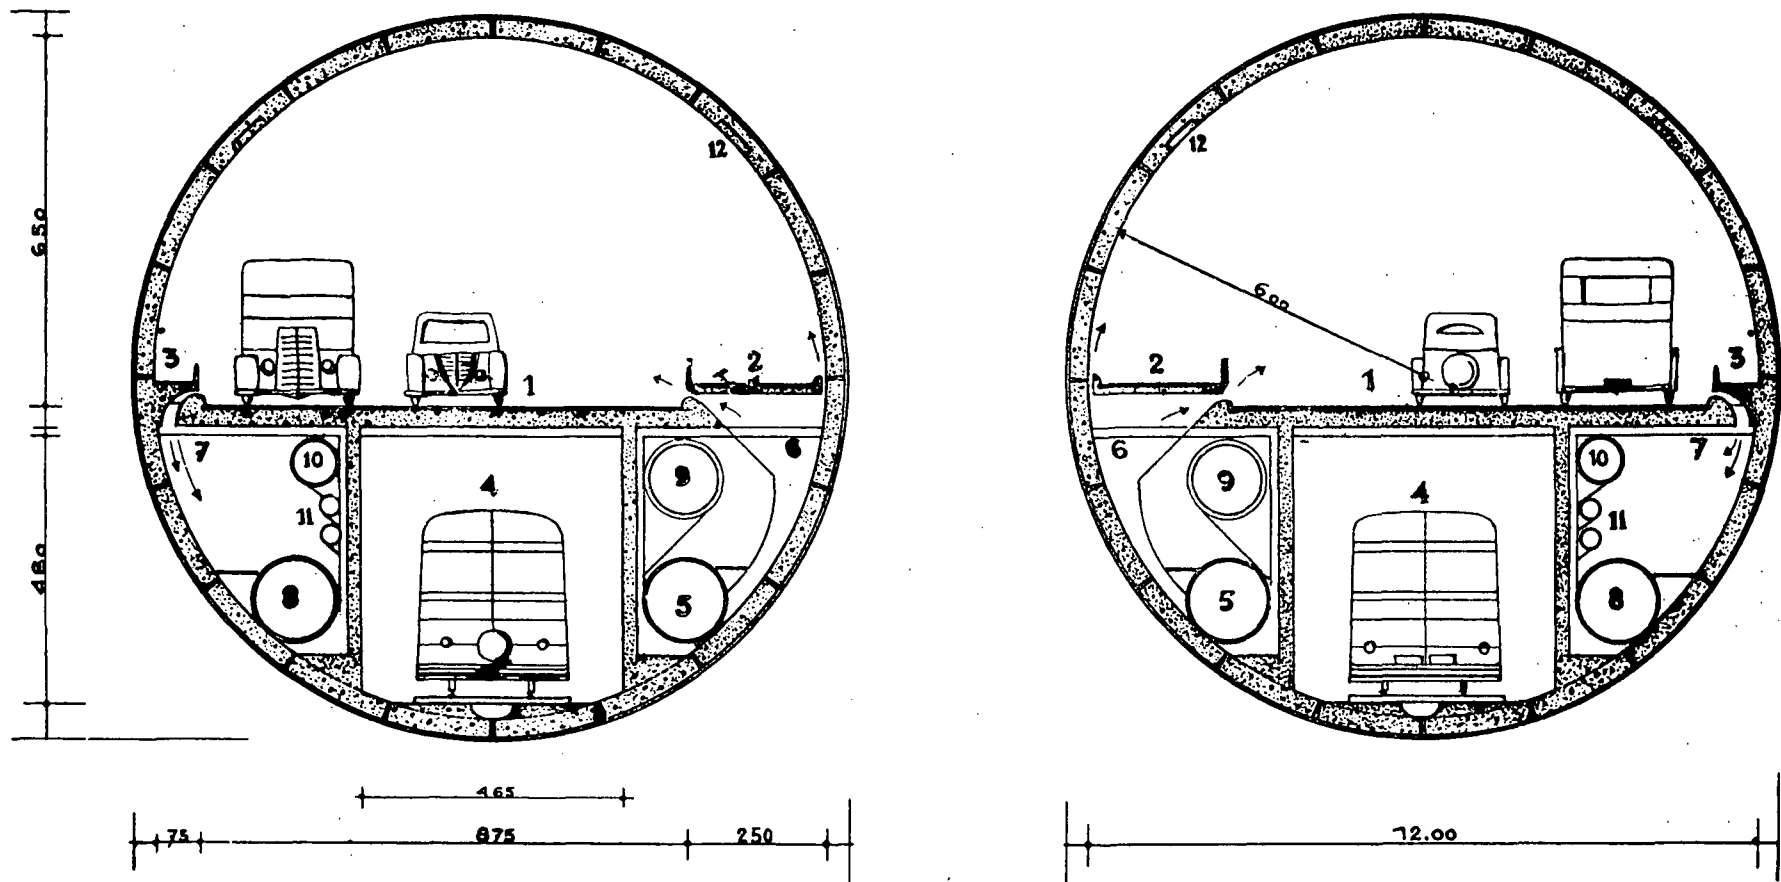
Coupe du demi tunnel routier Basdevant 1937
